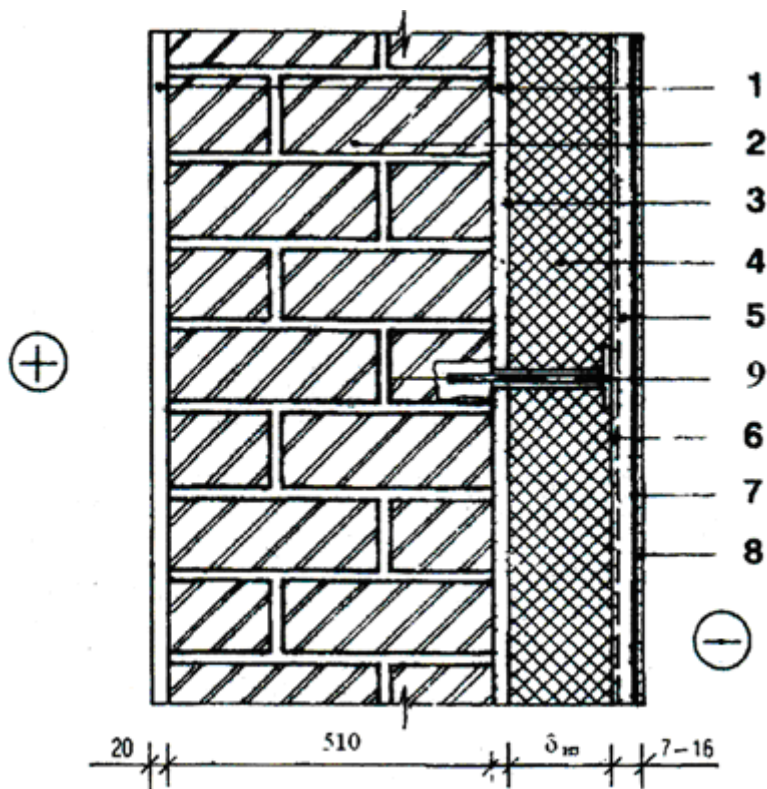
Схема утепления наружной стены с тонким штукатурным слоем:
